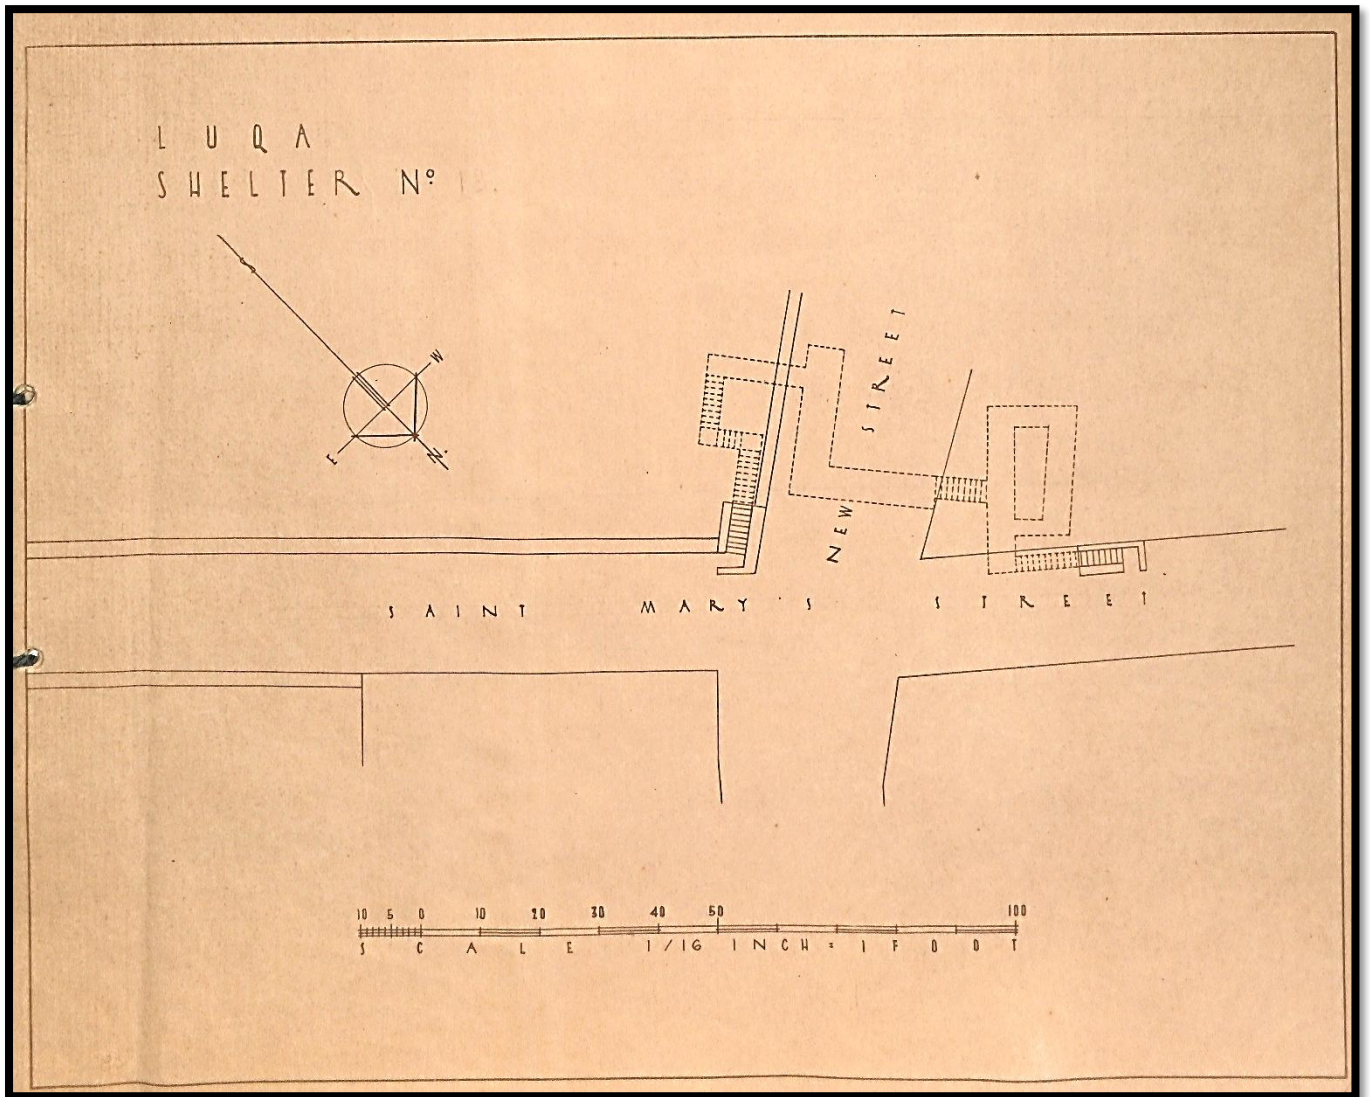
Planta do Abrigo nº13 "Saint Mary's Street – New Street"
